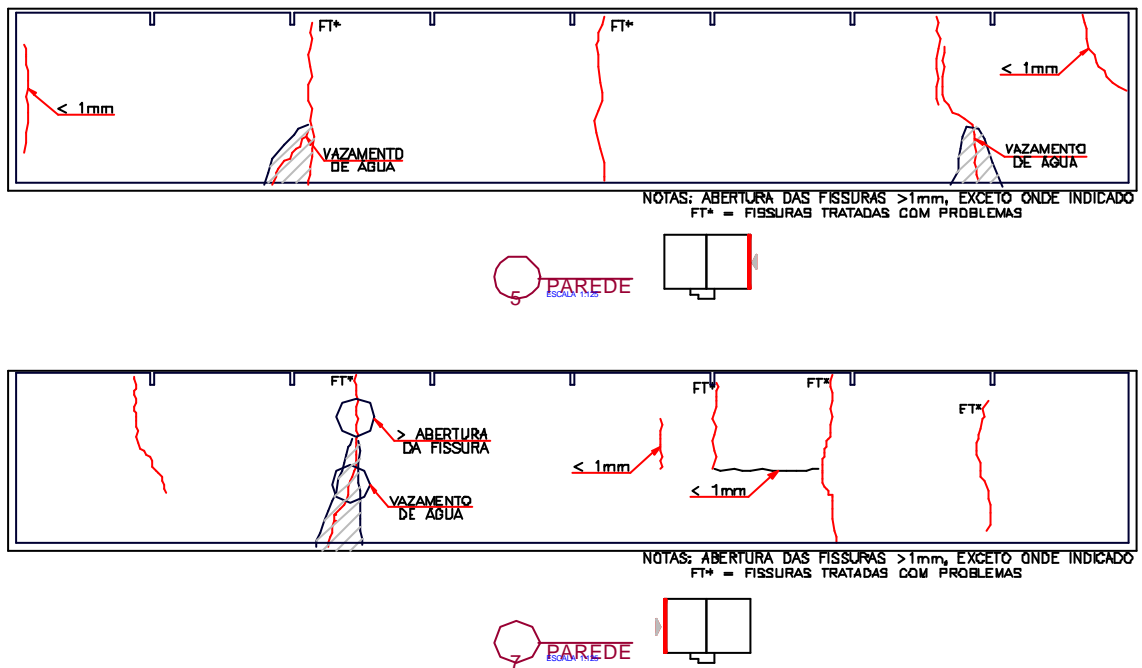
Mapeamento de fissuras nas paredes 5 e 7. (CHIMELLO, 2000).
